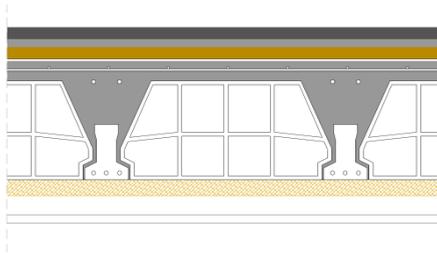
Forjado aislado en su parte inferior. 2014. AutoCAD.
